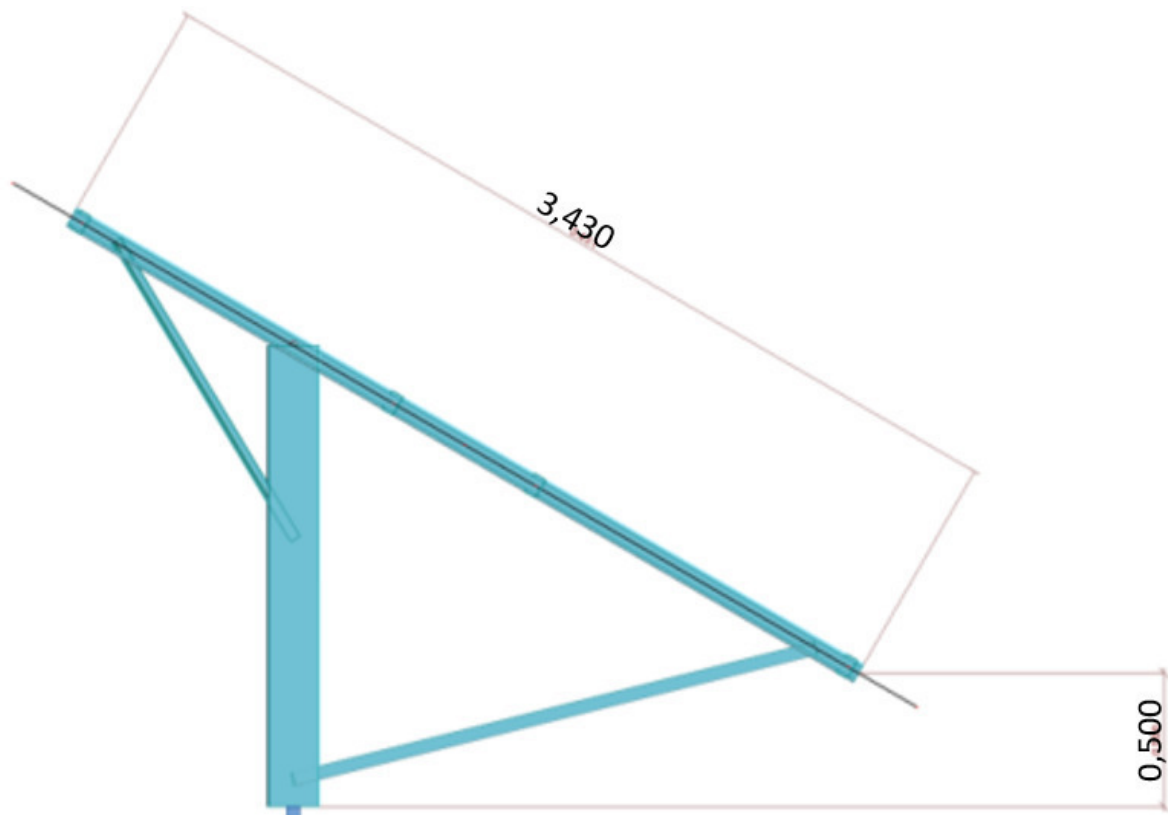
Vista em corte das mesas fotovoltaicas
